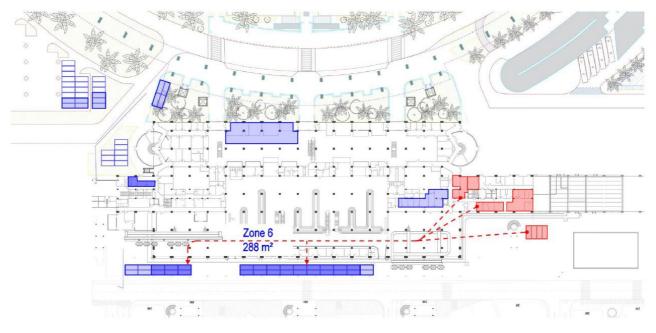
Exemple de repositionnement des installations de chantier temporaires au cours de l'avancement des travaux
